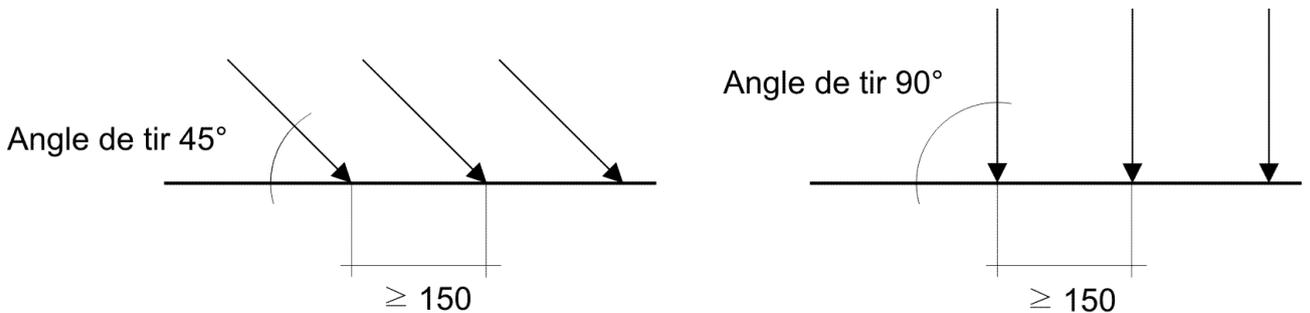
Angle de tir sur des éléments en bois, vus en coupe (dimensions en millimètres)
